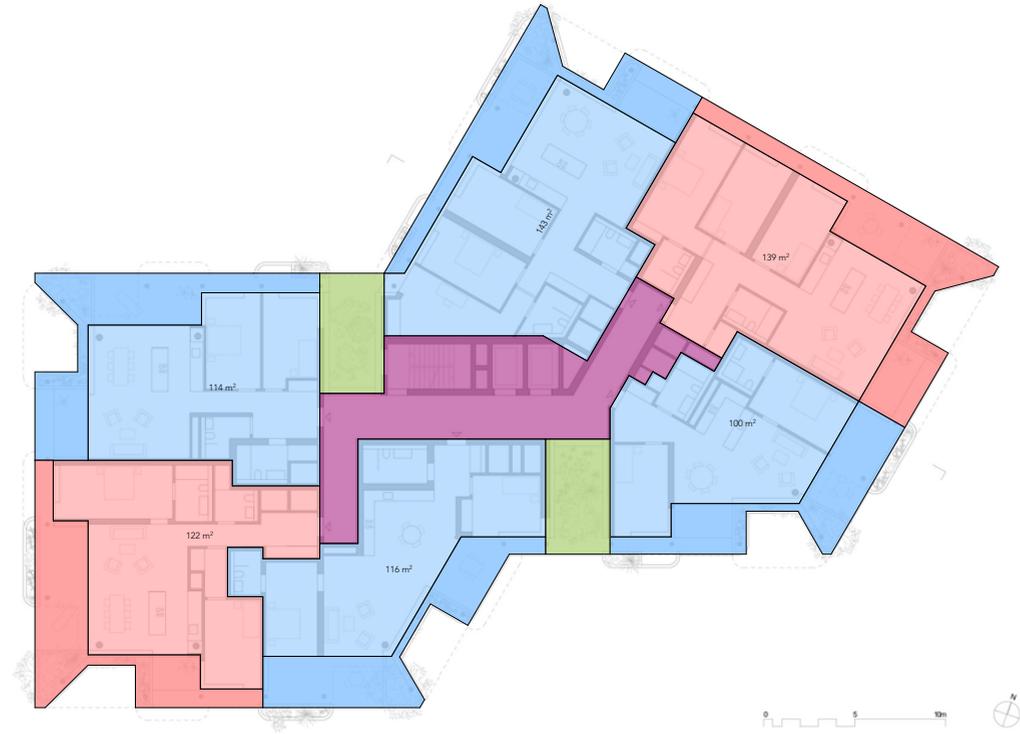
Analyse Grundriss B, Ramser Schmid Architekten
